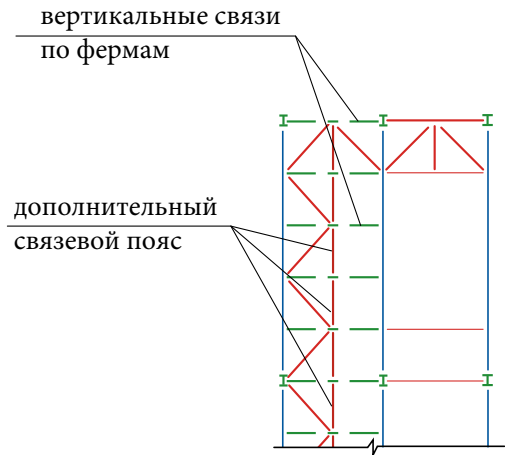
Решение поперечной связевой фермы при шаге ферм 12 м
